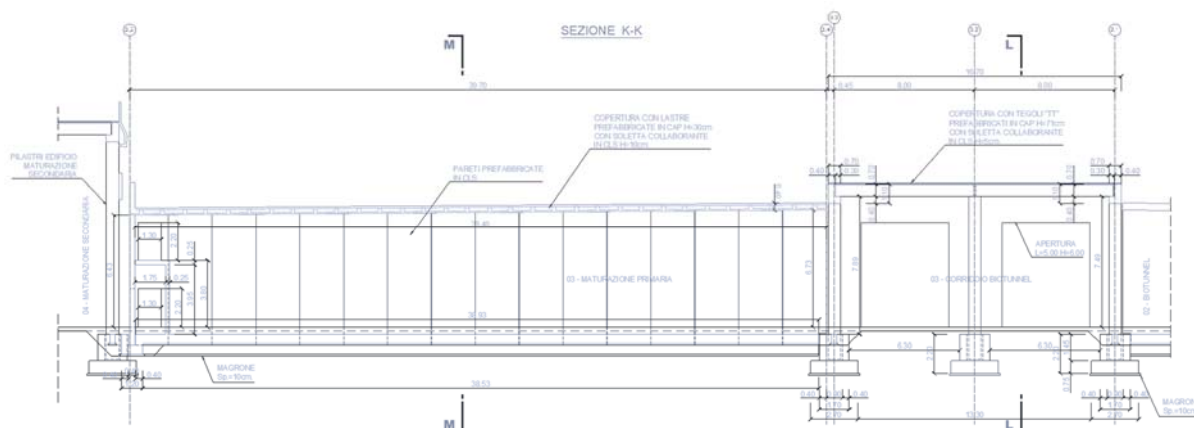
SEZIONE LONGITUDINALE MATURAZIONE PRIMARIA
